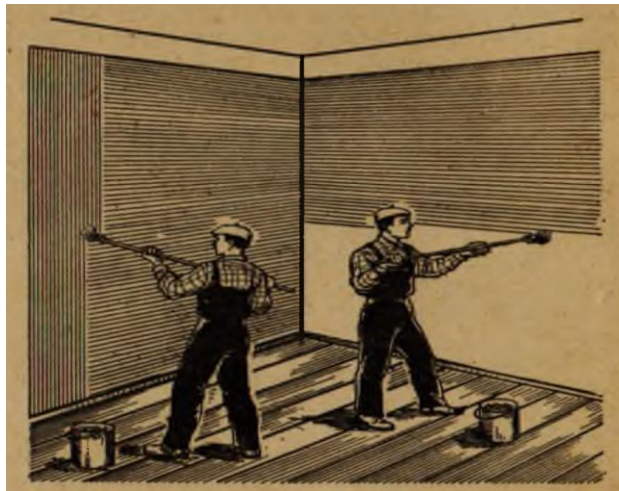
Грунтування поверхонь стін за допомогою щіток
